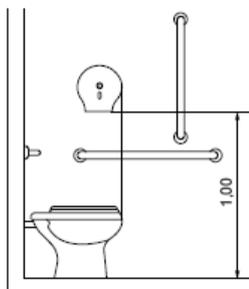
Localização da papeleira de sobrepor (rolo) – Vista lateral
